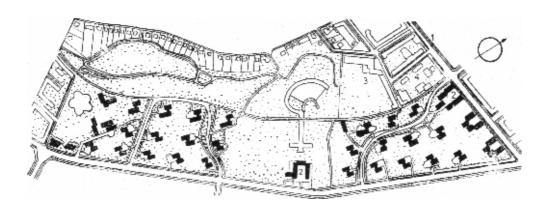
Застройка 12-этажными жилыми домами. Микрорайон Белахой, Дания, Генеральный план
